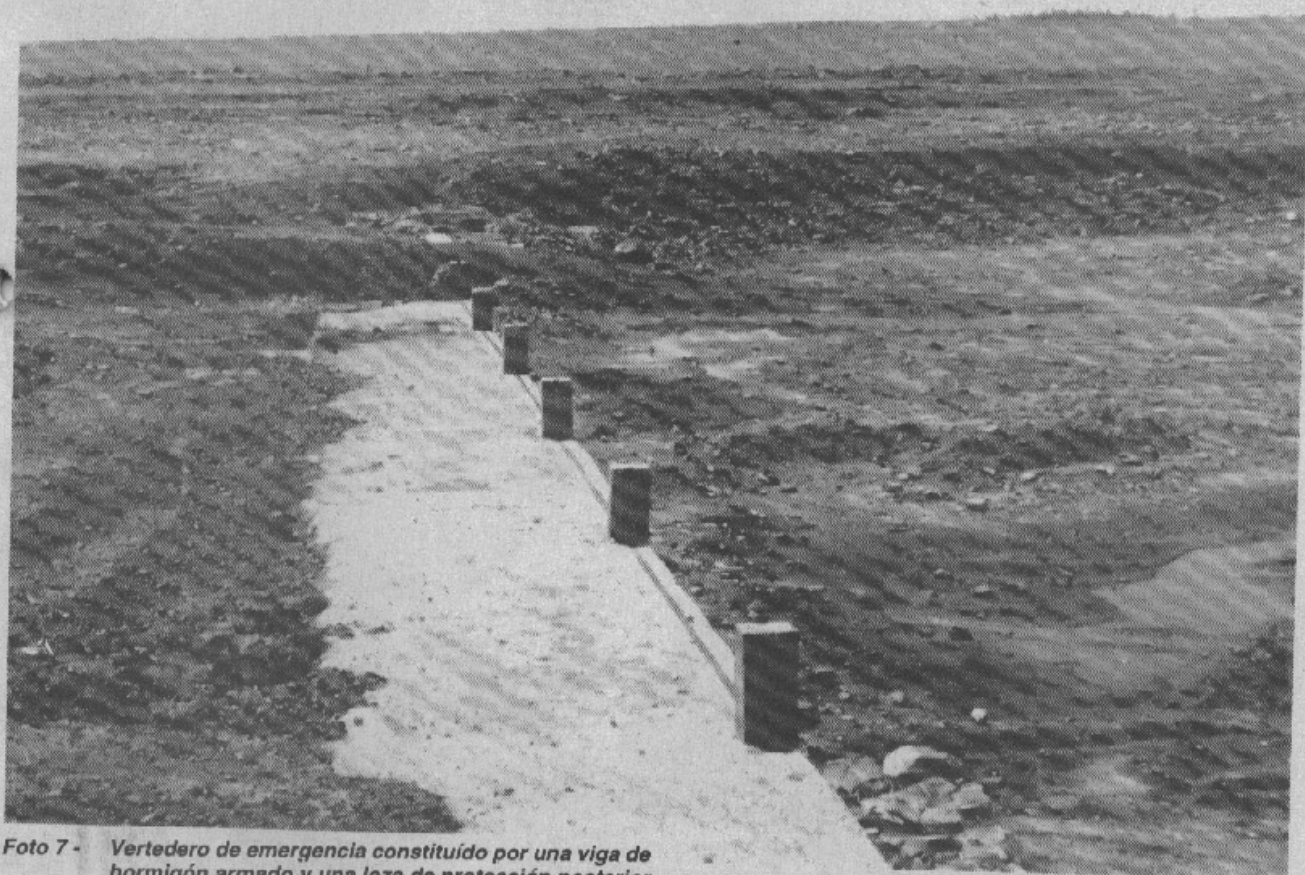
Vertedero de emergencia constituido por una viga de hormigón armado y una loza de protección posterior de 2 metros de ancho aguas abajo.
